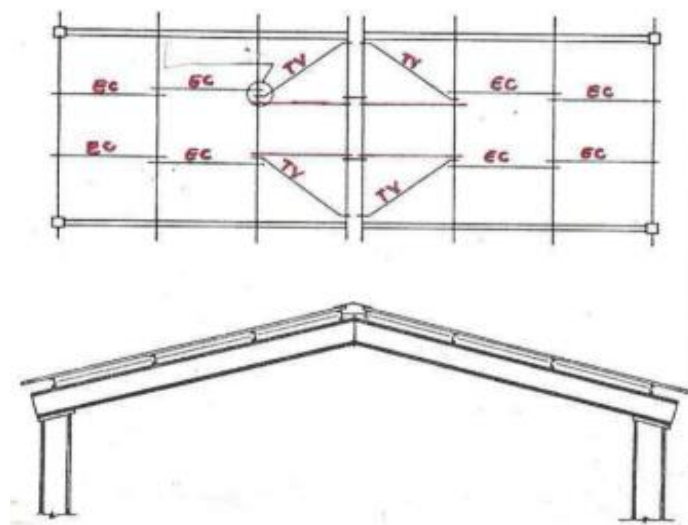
Espaçadores de terço (EC) e travamentos (TV) (De PAULA, 2016)
